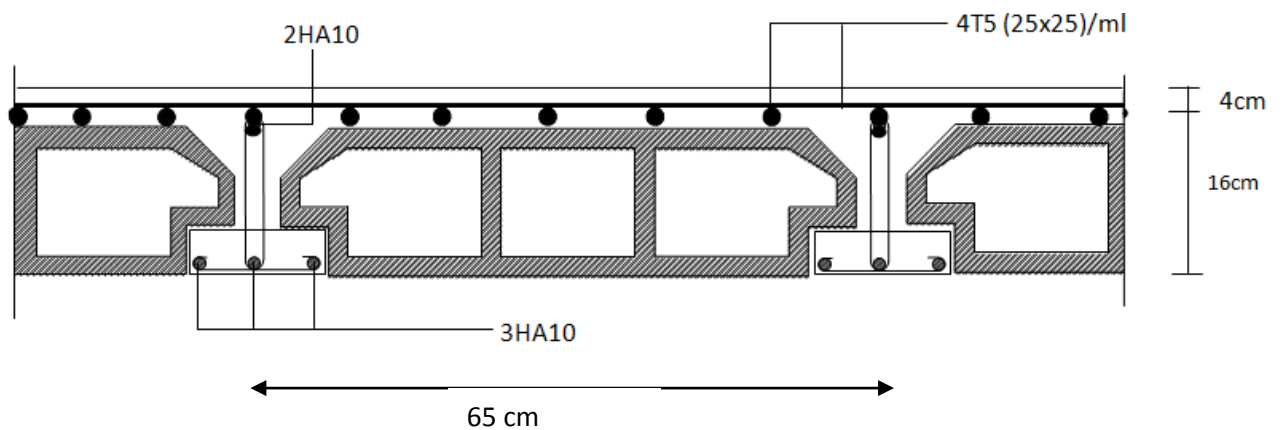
ferrailage de poutrelle en travée
